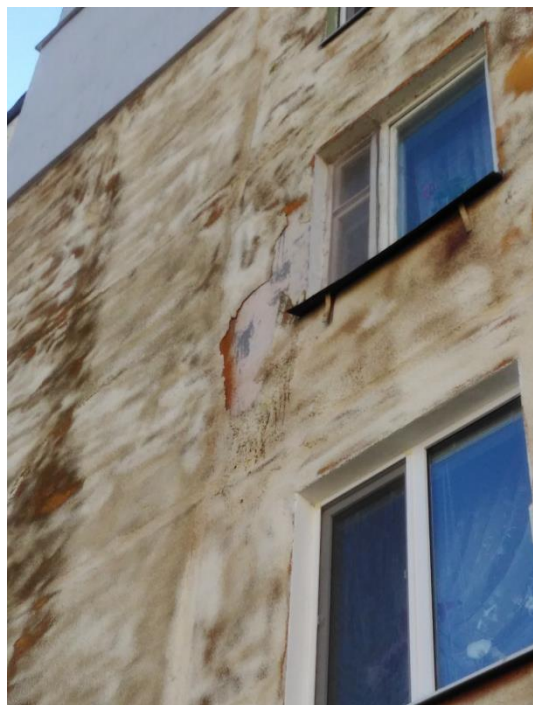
Общий вид наружной стены крупнопанельного жилого дома с разрушающимся теплоизоляционным слоем из ППУ
